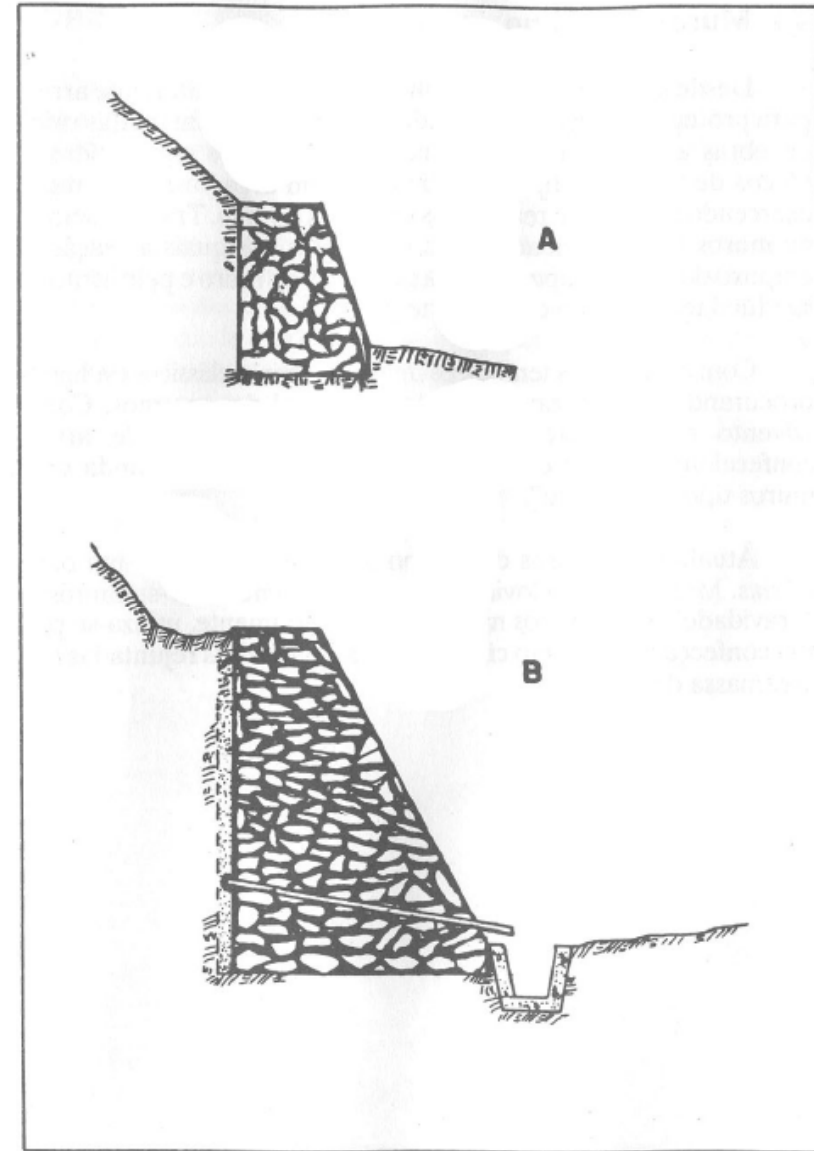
Muros tipo "gravidade". A - de pedra seca; B - de pedra argamassada
